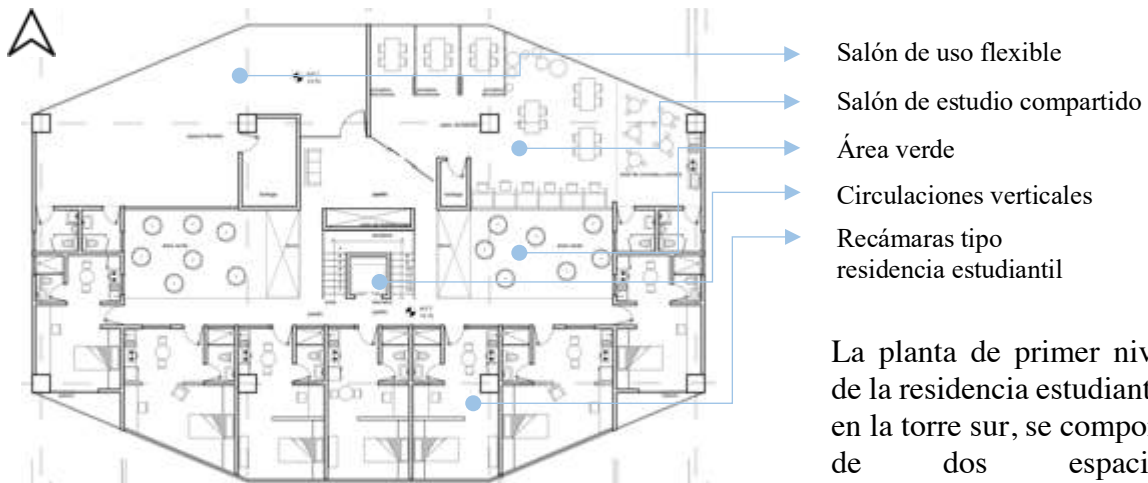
Planta primer nivel, torre sur. Fuente: Elaboración propia.
